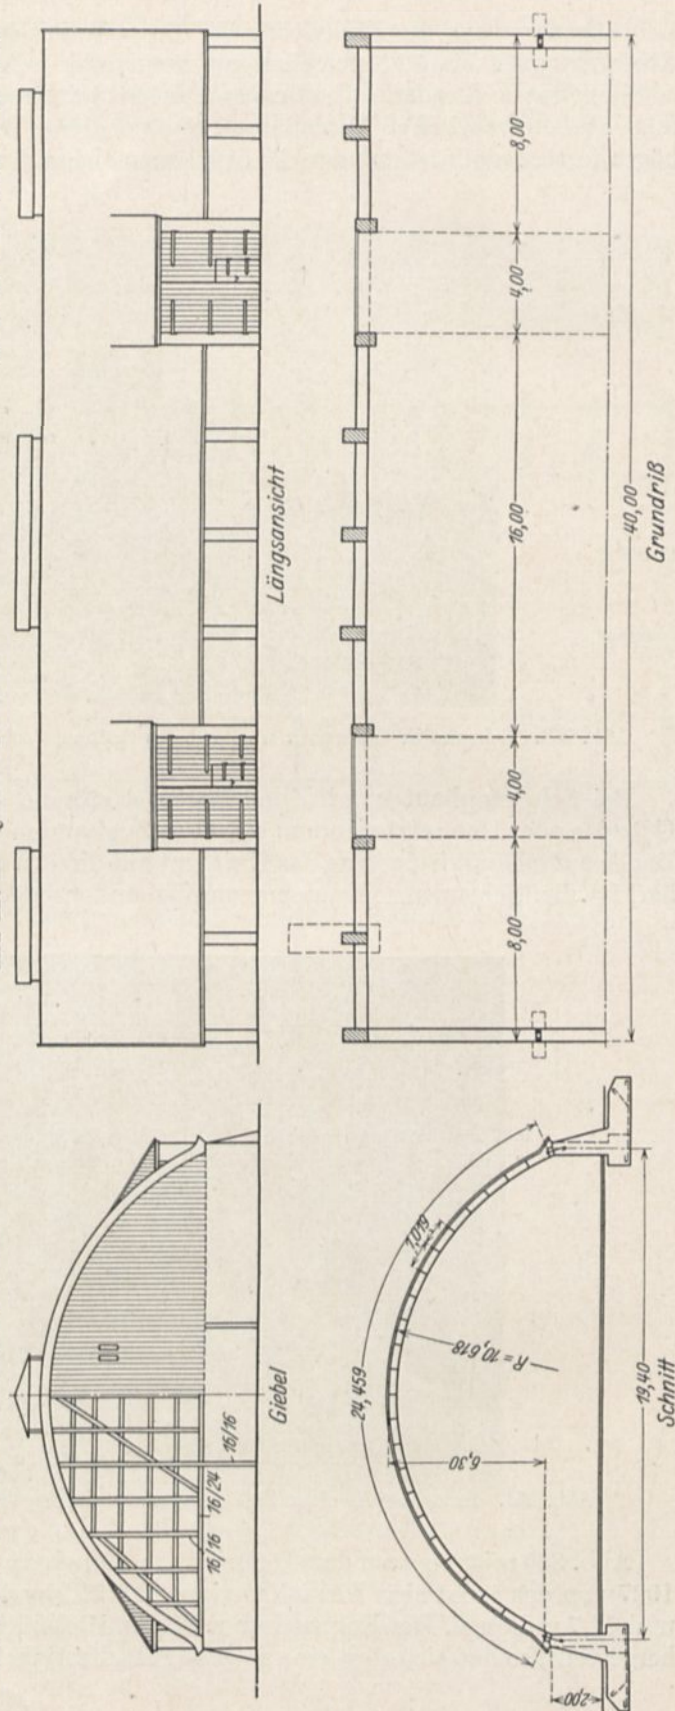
Zollbauscheune in Militisch (Schlesien) mit zwei Querdurchfahrten. (Ausführung: Europäisches Zollbau-Syndikat A.-G., Berlin.)
